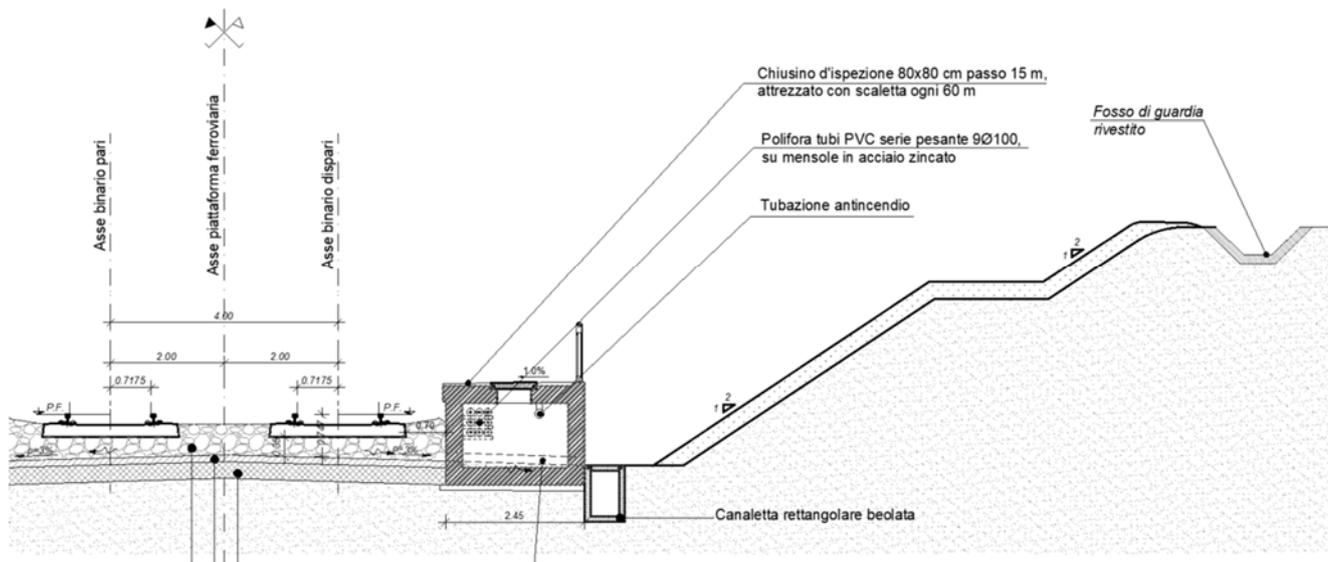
Sezione tipologica per il drenaggio in trincea con marciapiede
